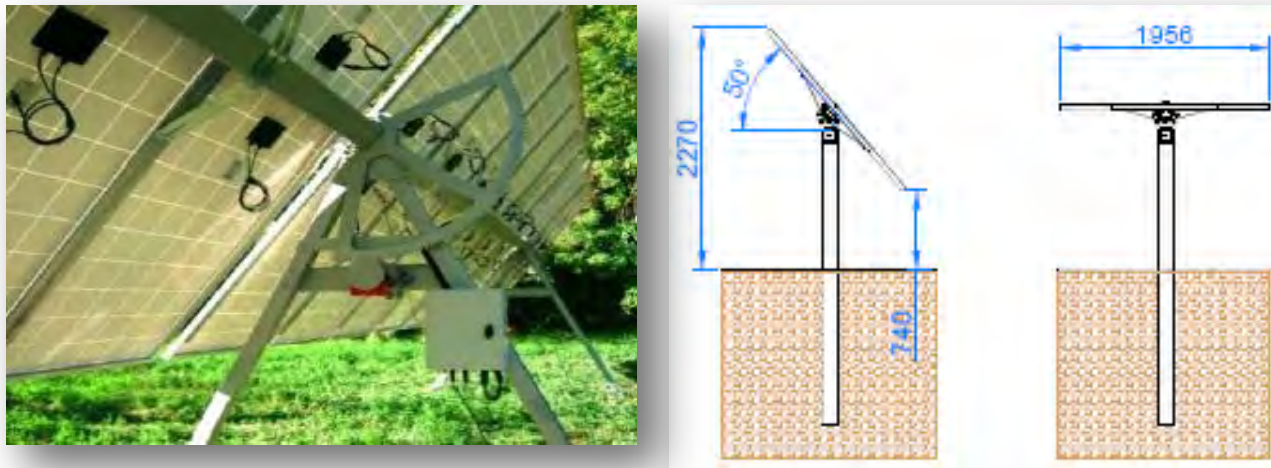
Plan en coupe structures support modules avec tracking en position plane et basse et système d'ancrage.
